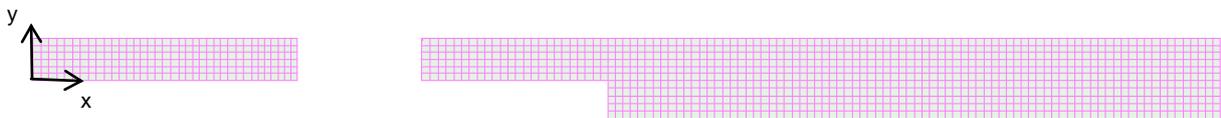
Sistema di riferimento - Vista in pianta soletta rampe/scale
